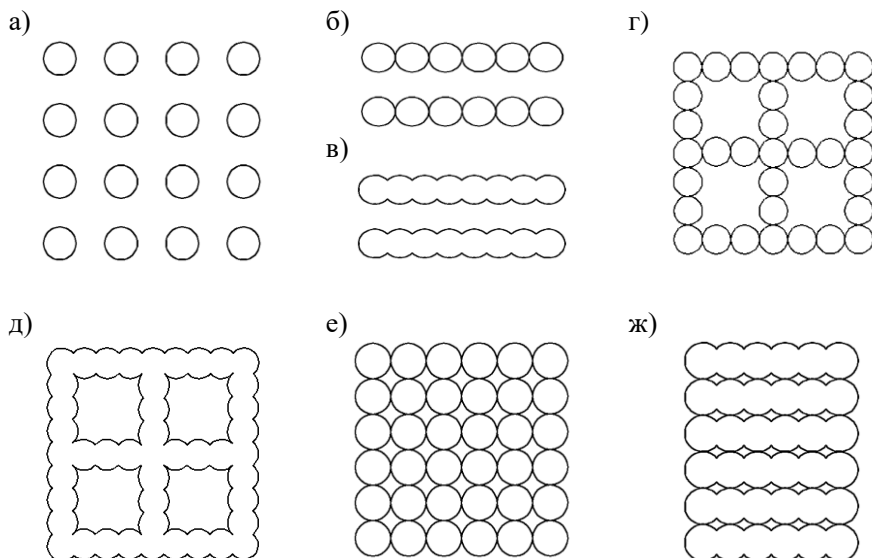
Конструктивные решения закрепления грунтов грунтоцементными элементами: а) – отдельно расположенные ГЦЭ; б), в) – панели из ГЦЭ; г), д) – сетки из ГЦЭ; е), ж) – блоки из ГЦЭ
